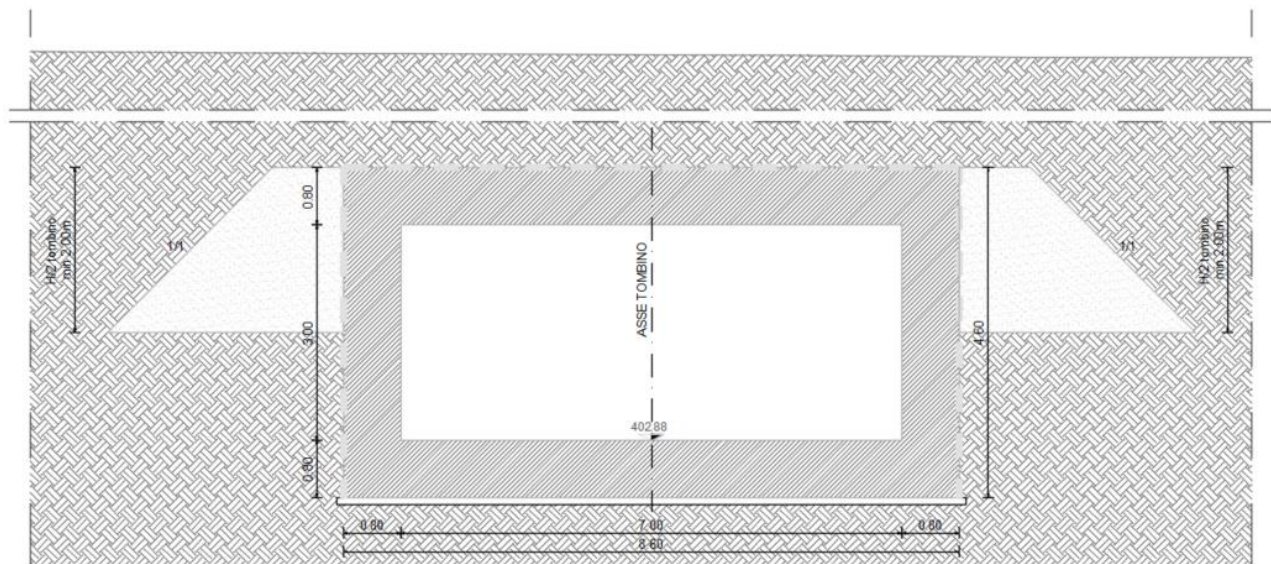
Sezione trasversale corrente e in corrispondenza dei pozzi
